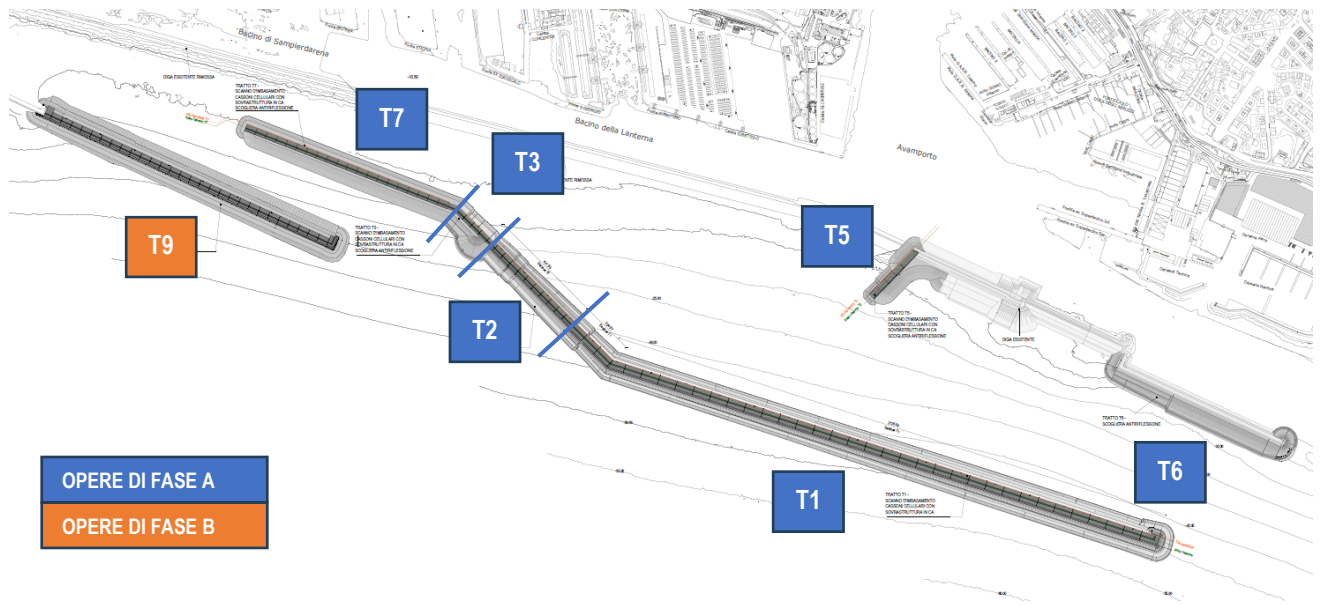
Nuovo layout Fase A+B con identificazione delle singole opere
